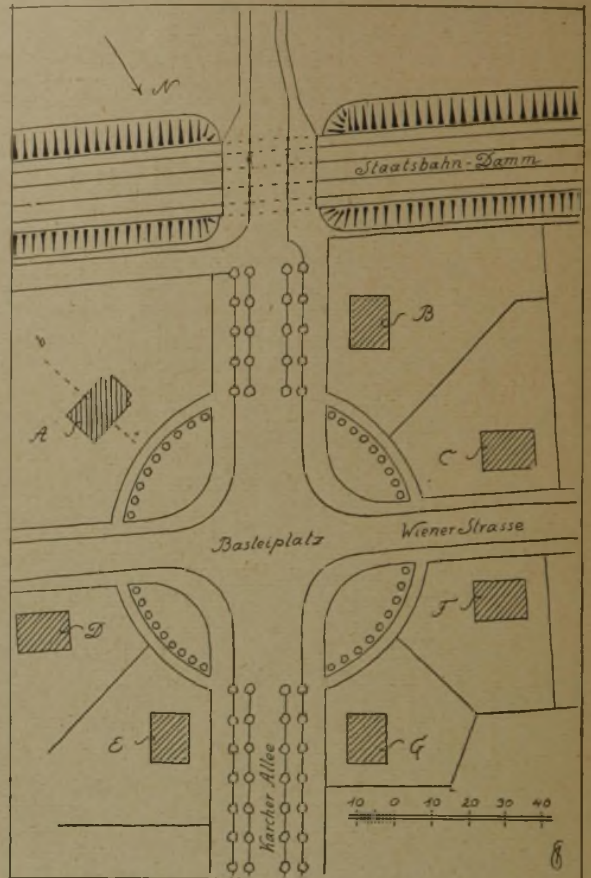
Vollständige Bebauung nach dem heutigen Plan.
